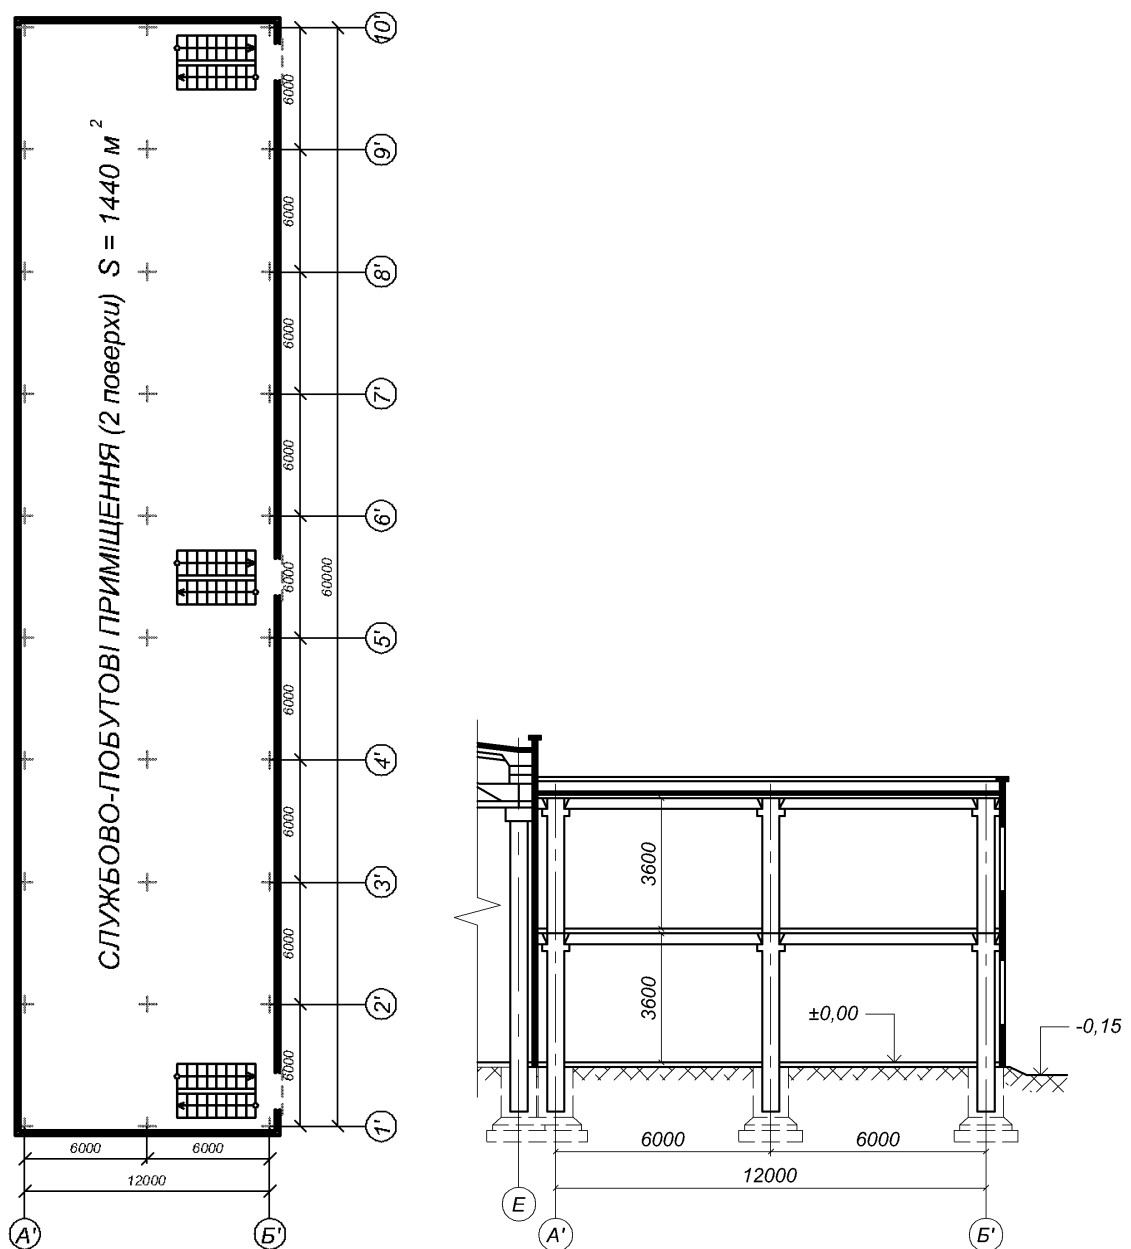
Схема планування і поперечний переріз службово-побутових приміщень цеху
